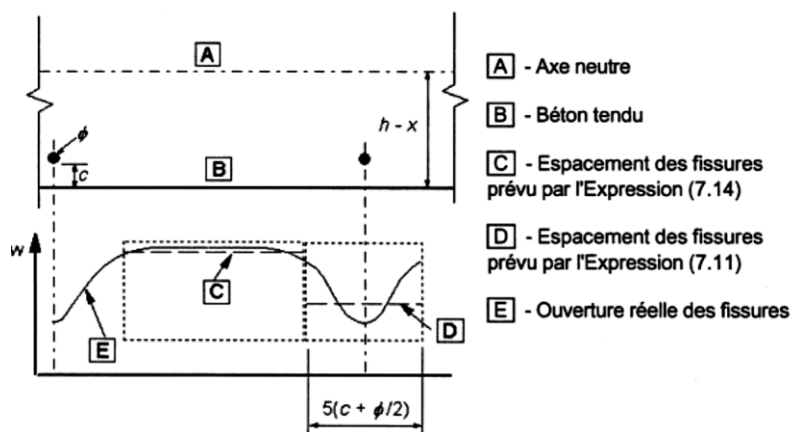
Ouverture des fissures w à la surface du béton en fonction de la distance aux armatures
